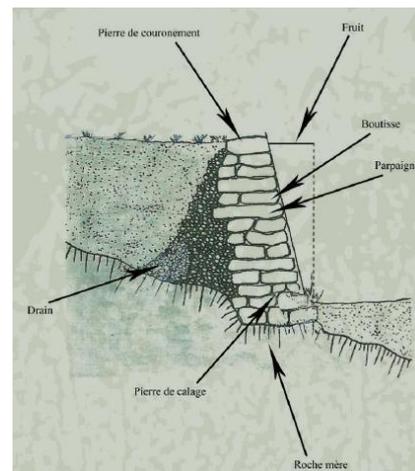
Mur de soutènement en pierre sèche : l'écoulement des eaux
